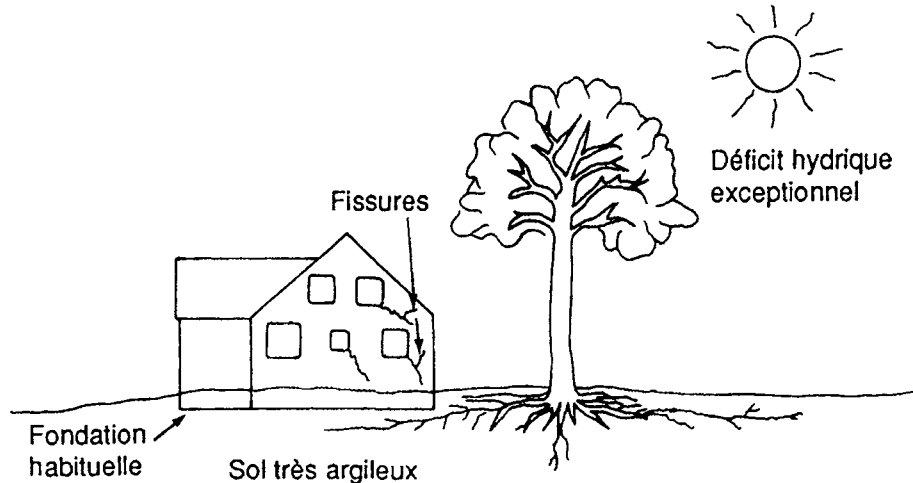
Sur un sol très argileux, au cours d'une sécheresse importante, un arbre trop proche entraînera des fissures dans les superstructures d'un bâtiment (à moins d'avoir prévu des fondations plus importantes).
